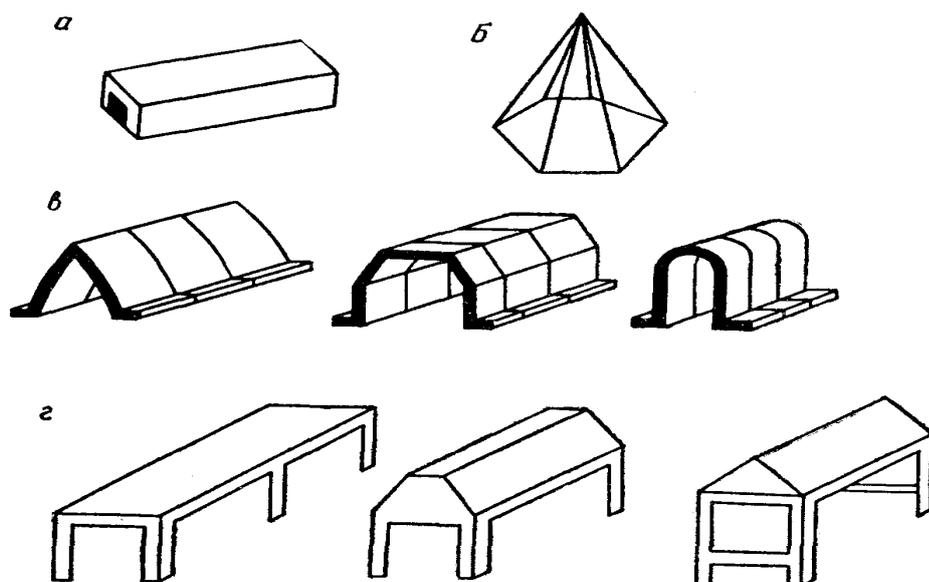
Защитные устройства для ценного оборудования: а—камеры; б- шатры; а—съемные кожухи; г—зонты
